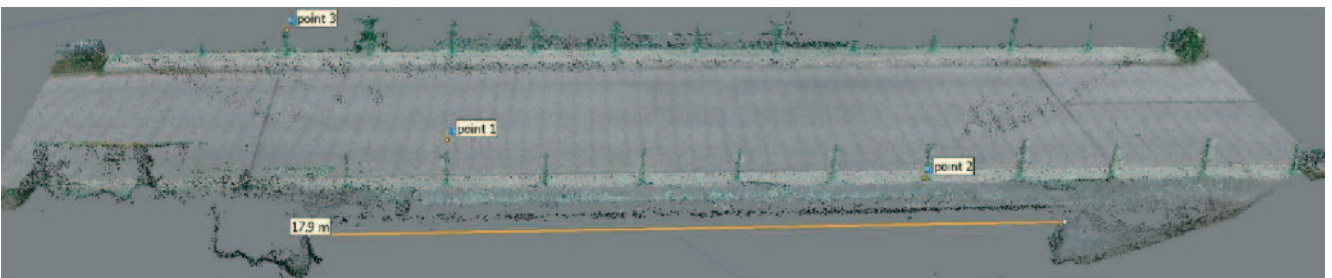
Photogrammetrische Punktwolke der Betonbrücke bei Ebersbach
